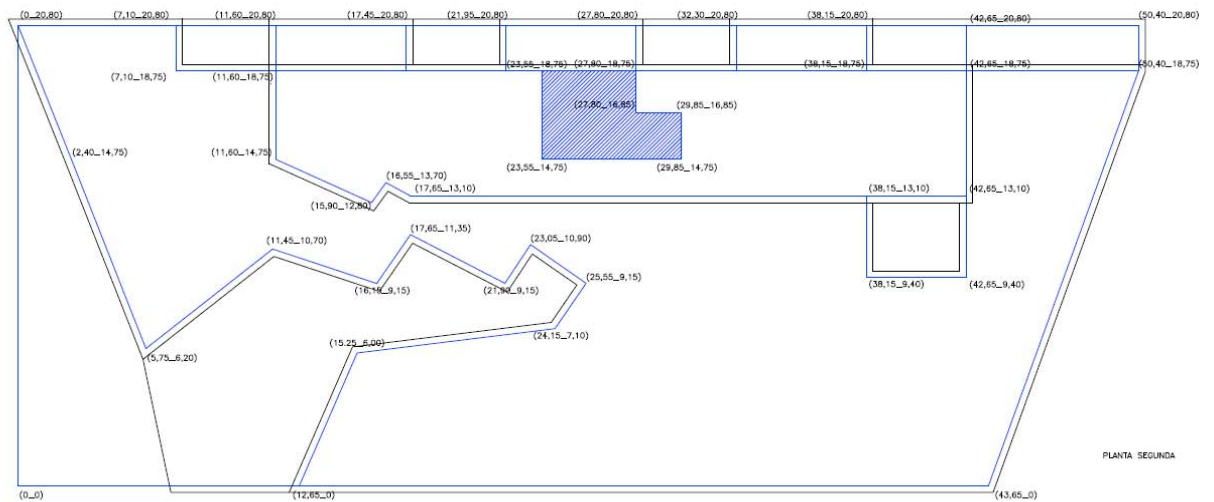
Planimetría auxiliar. Plantas y subdivisión en espacios.
